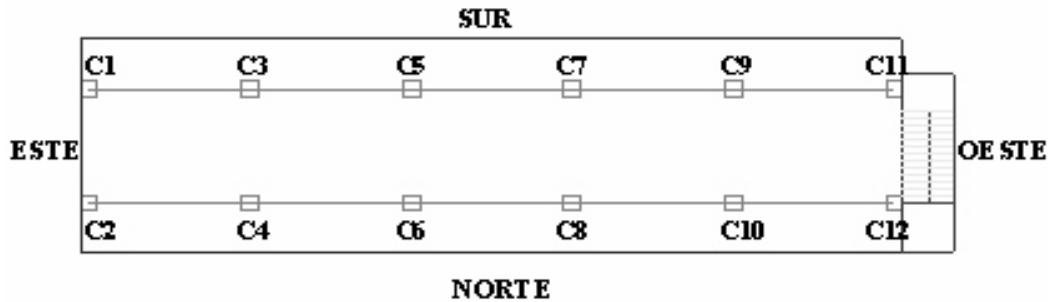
Identificación en planta de columnas de la estructura de la planta de vapor.
